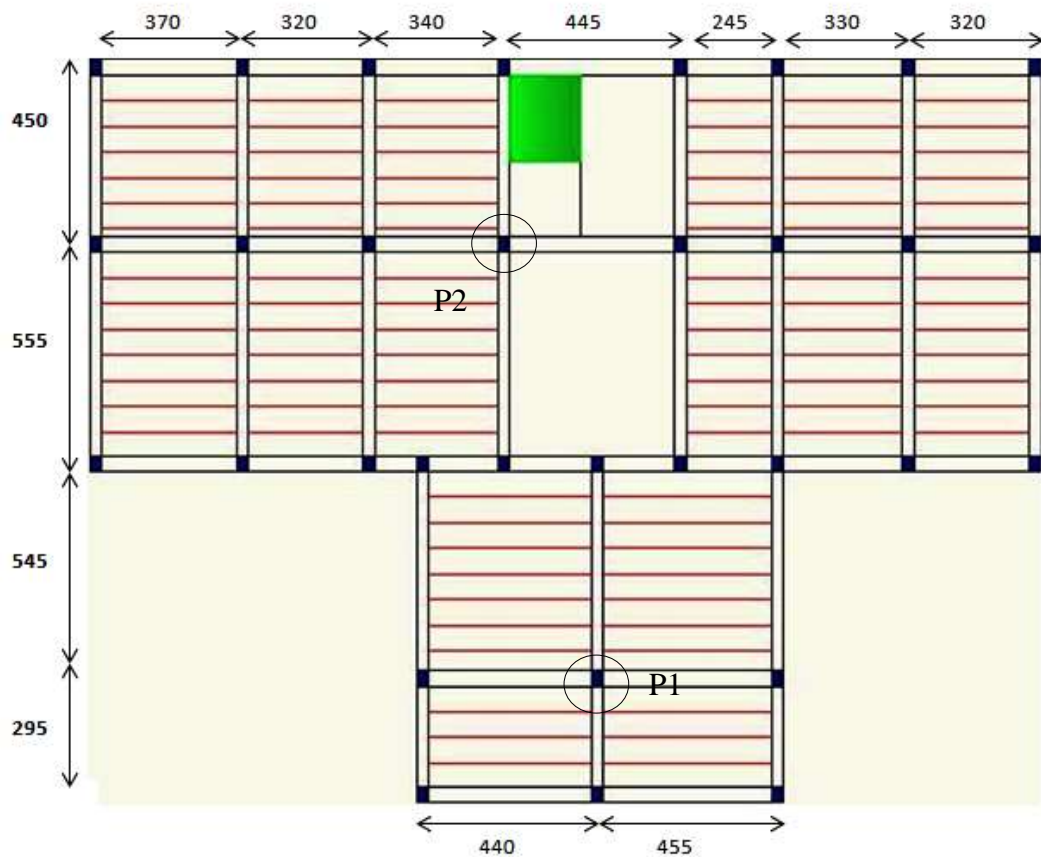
Plan de disposition des poutrelles (1^{er} étage)
